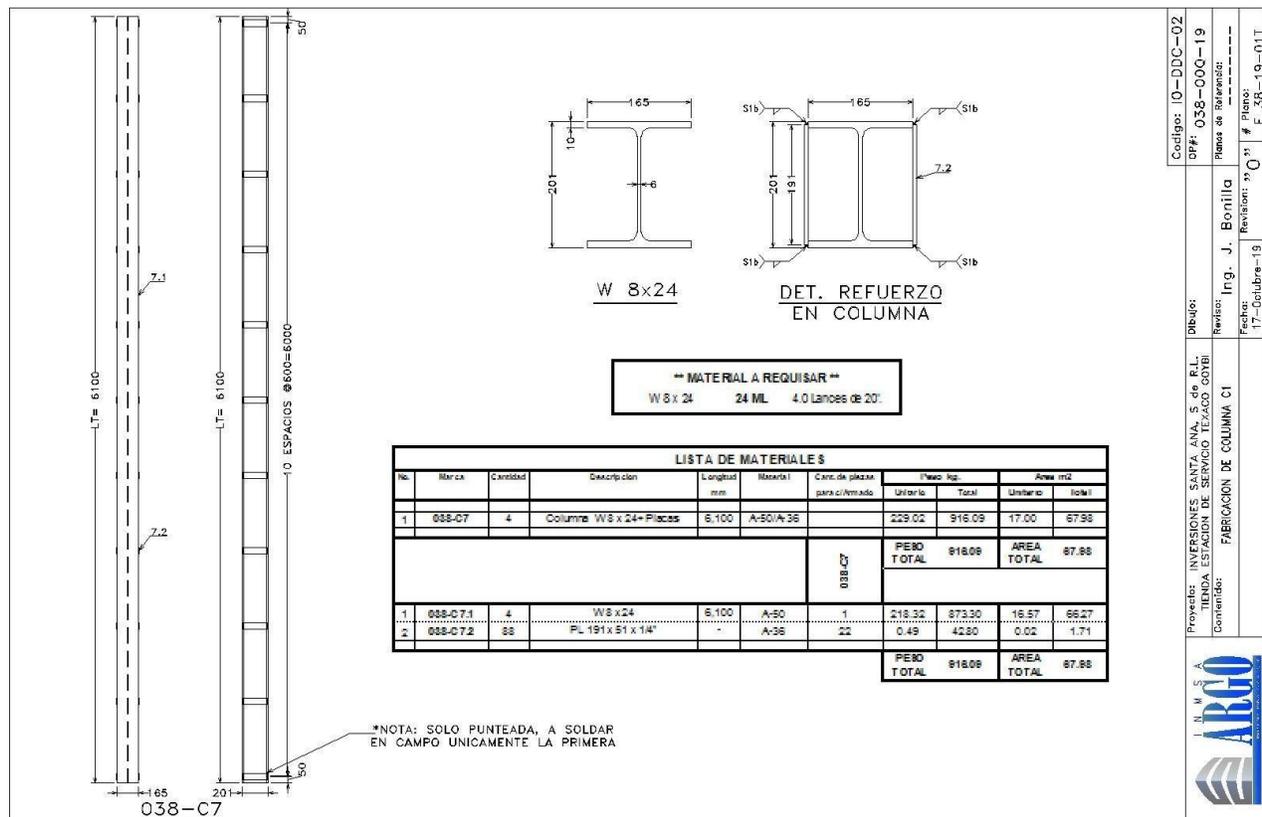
Plano para fabricación de columnas, Tienda de conveniencia
